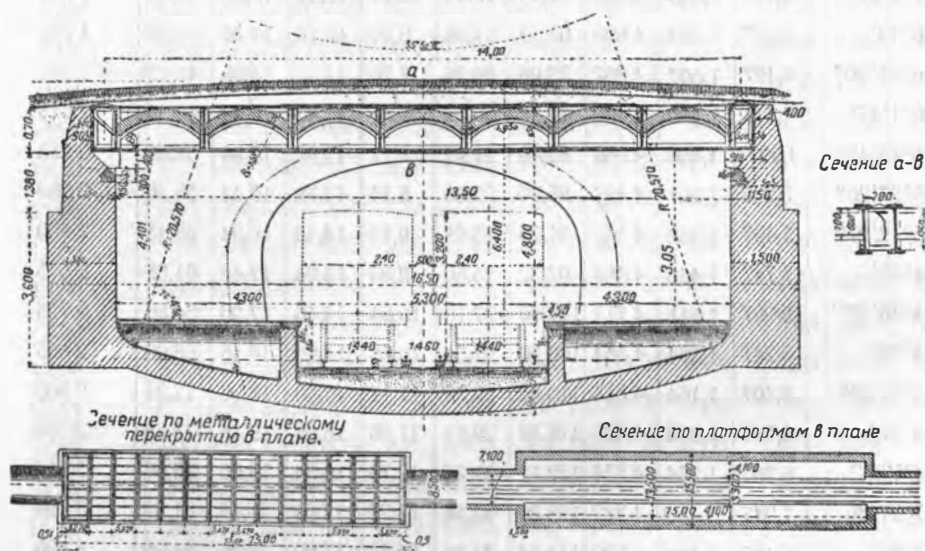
Станция метрополитена с плоским металлическим перекрытием
